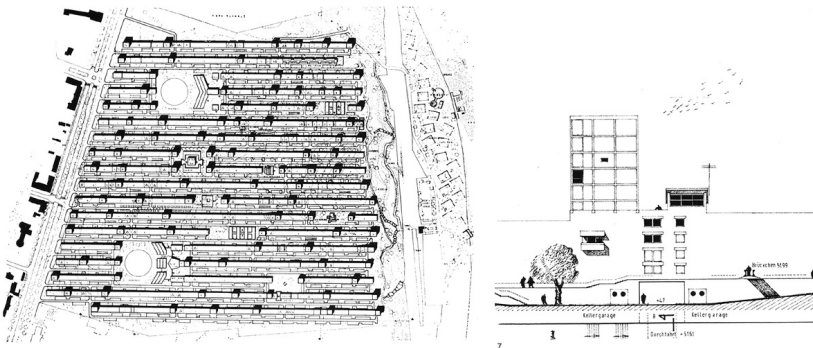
Lageplan (links), Detailansicht mit Turm und Durchgangssituation (rechts)
